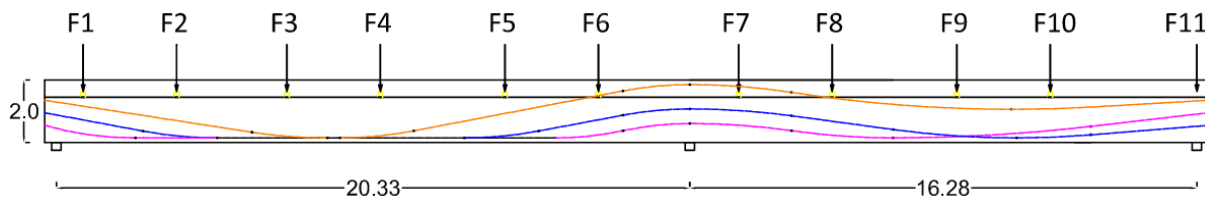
Traçado dos cabos de pré-esforço para a viga B8
